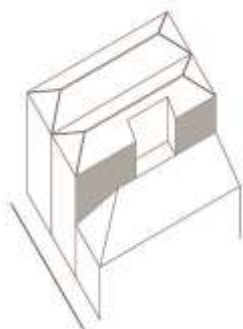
| Empena lateral mutilada com recorte singular e coroamento plano de água-mestra. A interrupção é provocada por um pátio interior. (desenho do autor)
